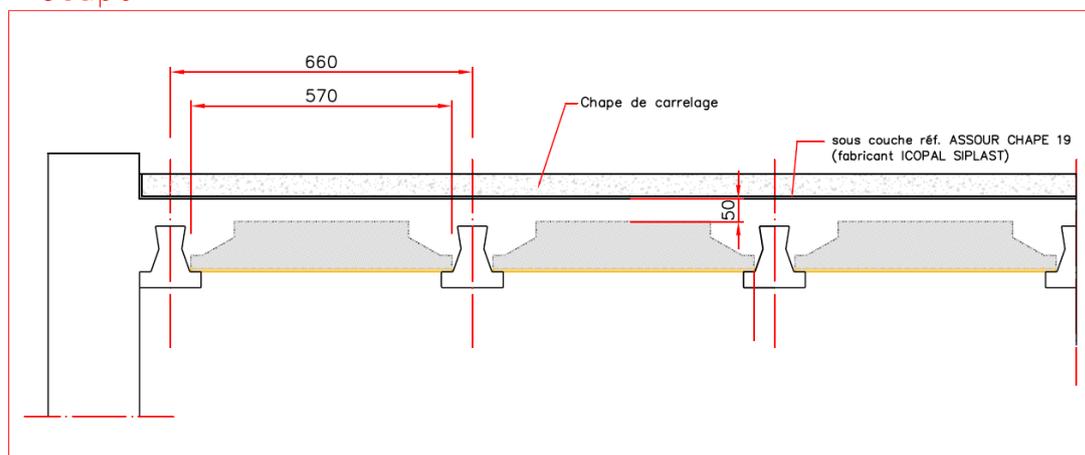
## PHOTOS ET PLANS D'UN PLANCHER AVEC CHAPE FLOTTANTE
